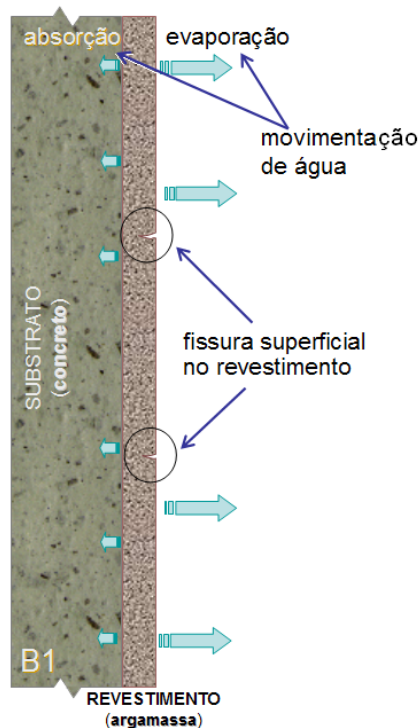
Ilustração do aparecimento de fissuras no revestimento de argamassa.
